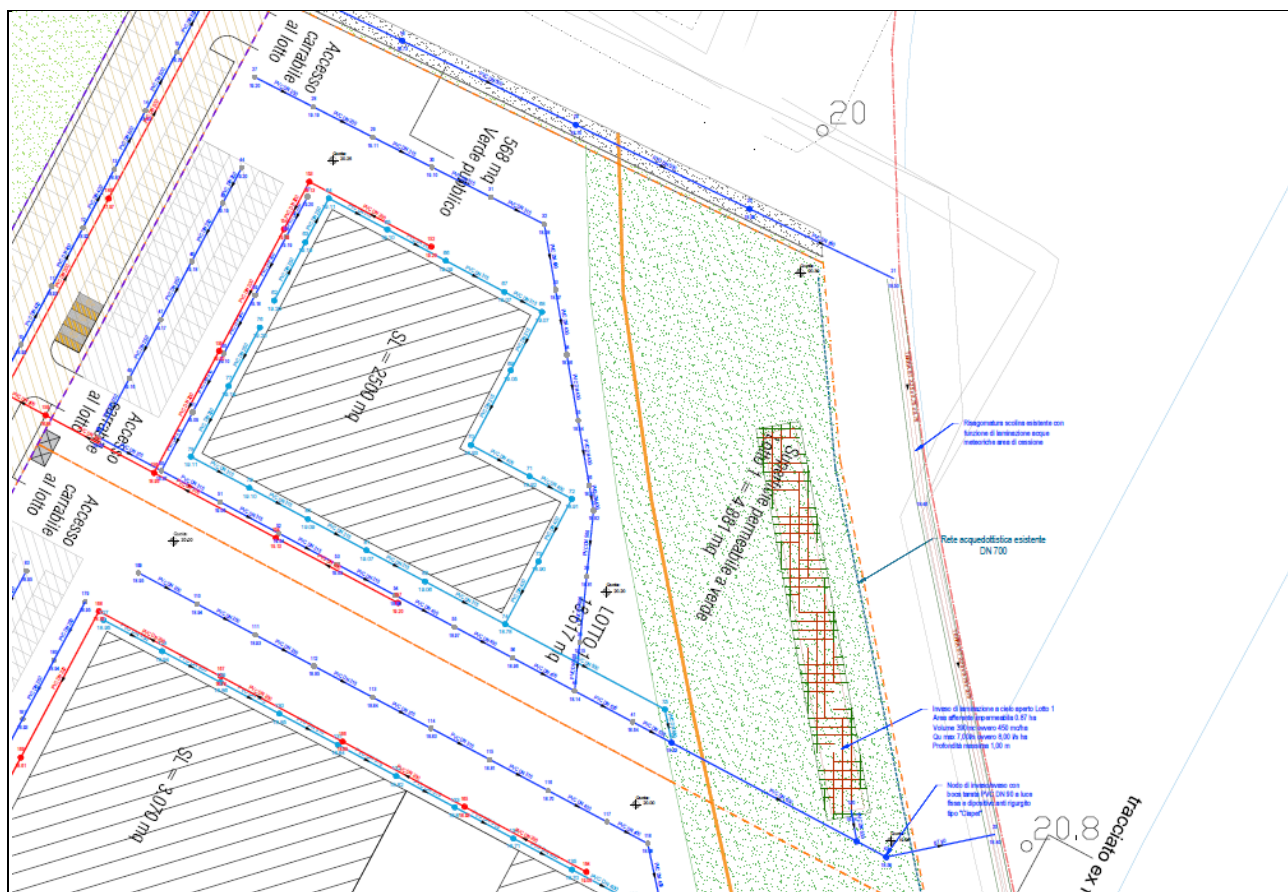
Inquadramento planimetrico volume di laminazione Lotto 1
